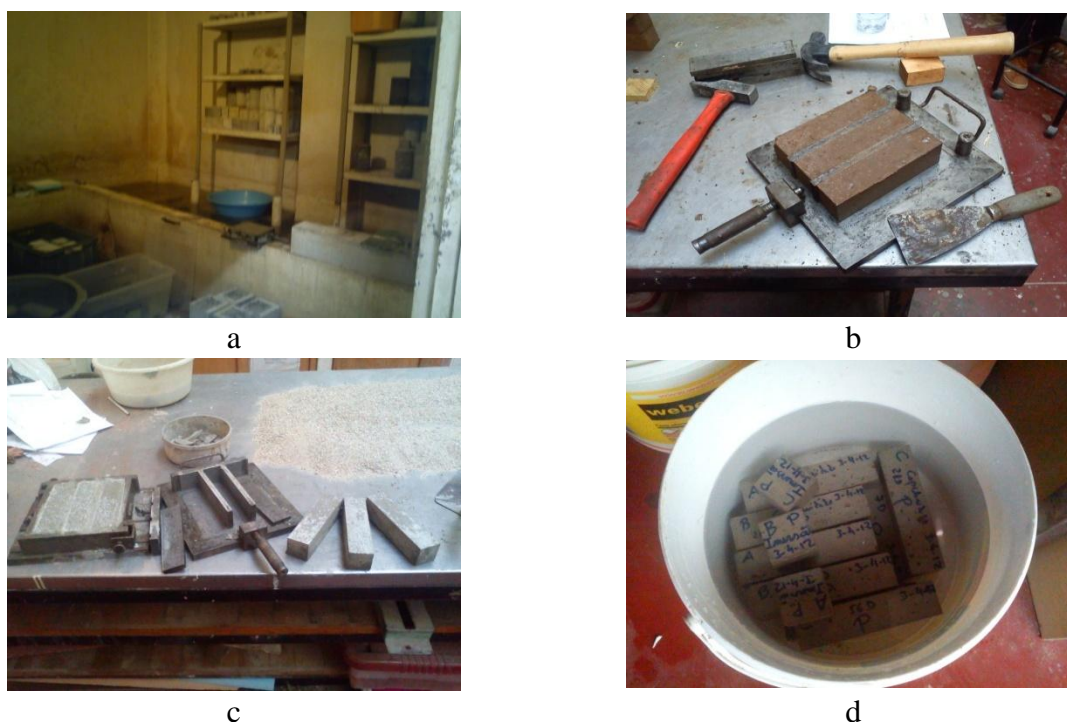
a) Camara Húmida b) Desmoldagem c) Molde com provetes, sem provetes e os provetes já desmoldados d) Armazenamento dos provetes em água
